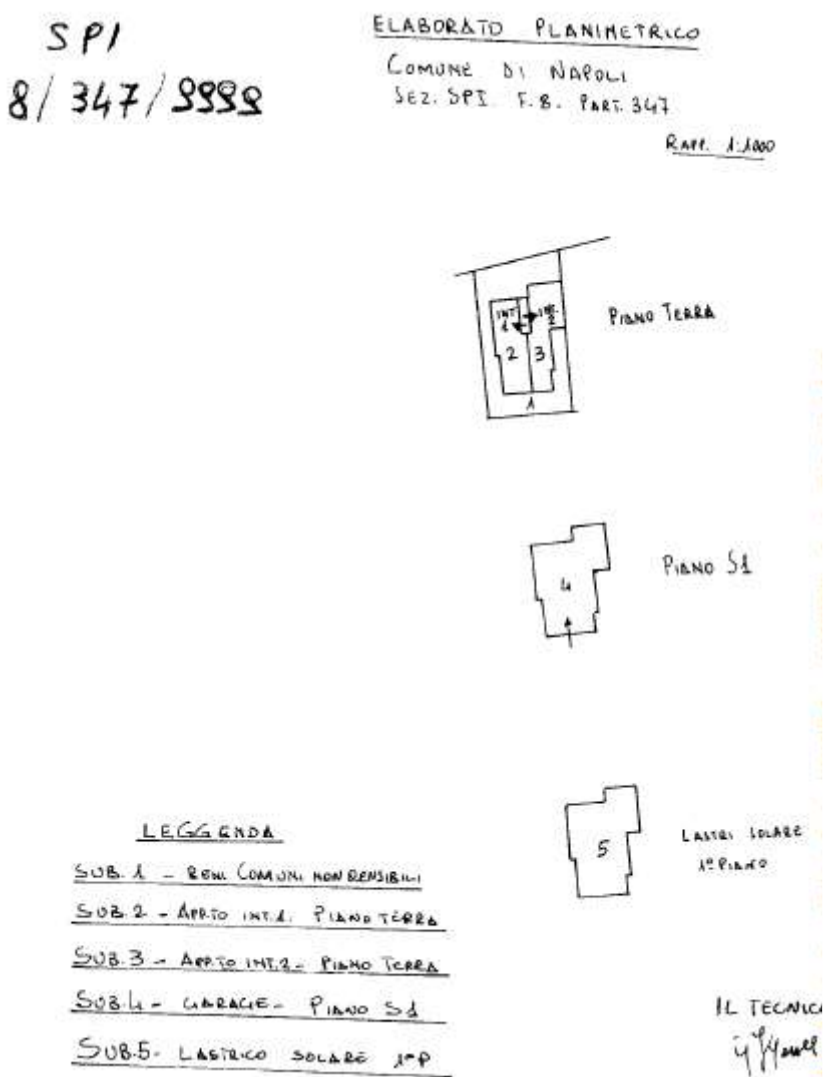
Stralcio Elaborato planimetrico (cfr. allegato n°2)
